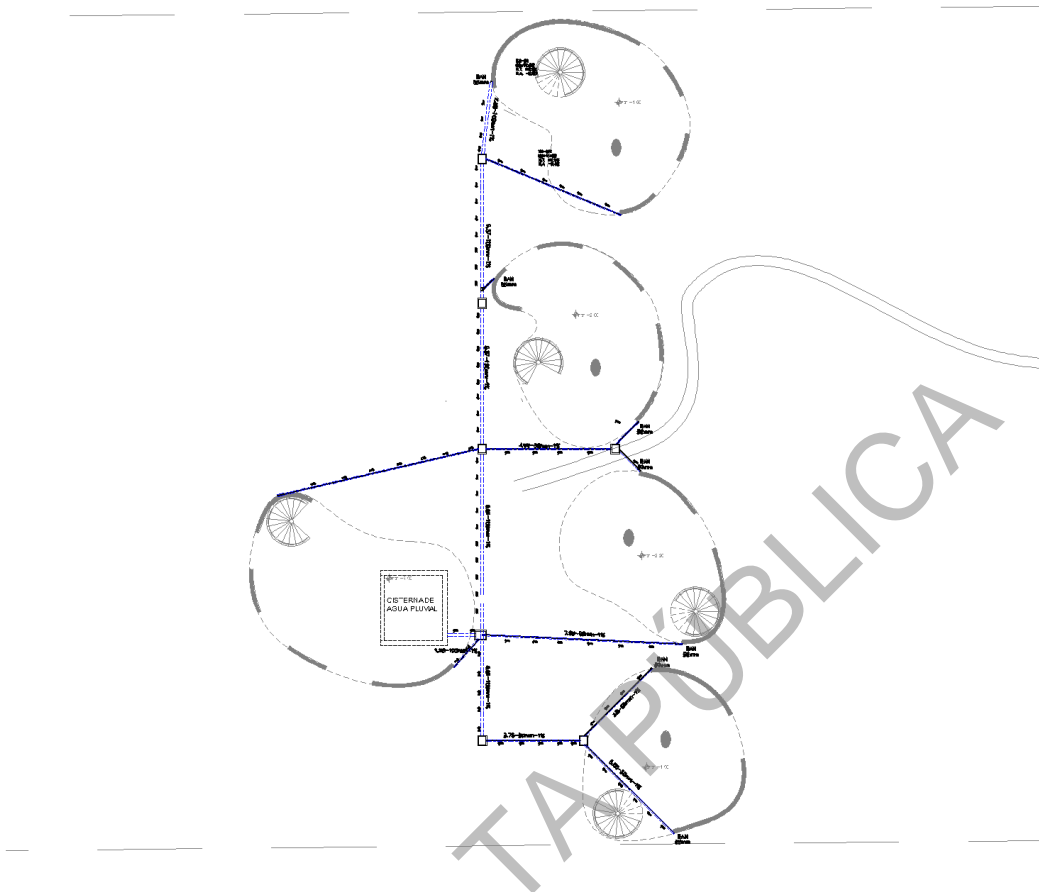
Ubicación de sistemas y líneas de captación de agua pluvial en planta baja.
